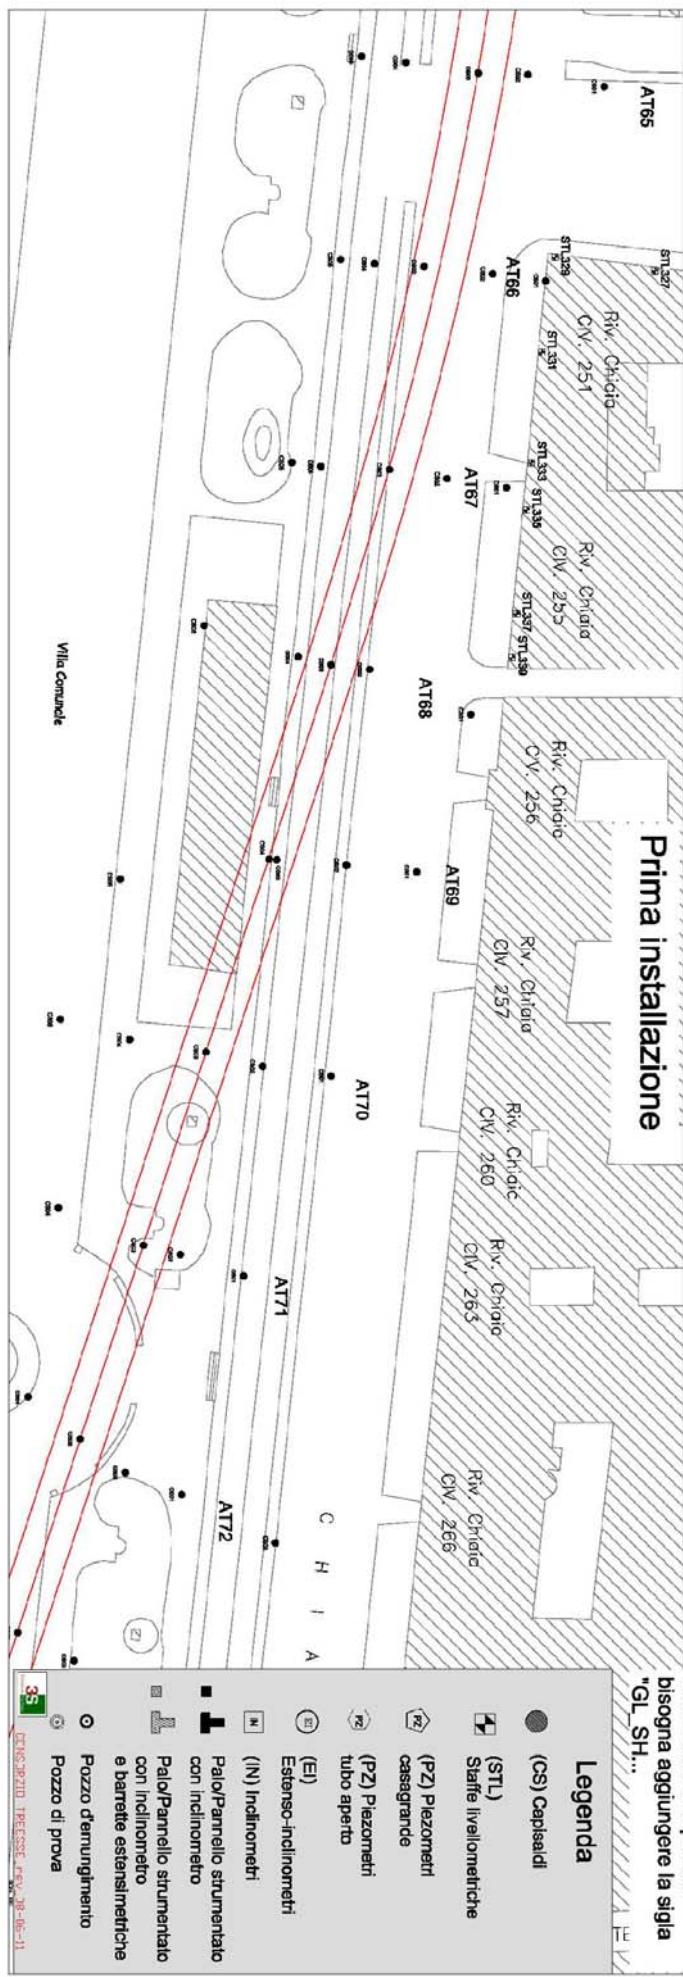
Planimetria tratta San Pasquale - Chiaia, raffigurante la disposizione della prima installazione della strumentazione di monitoraggio.
